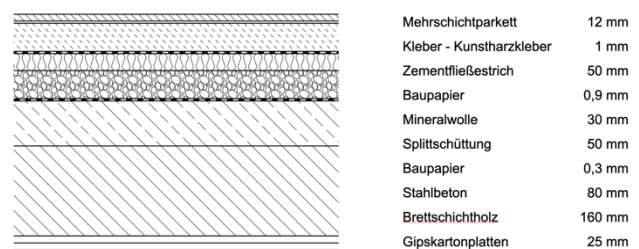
Detail Deckenaufbau Stahlbeton-Hohldielecke (maßstabslos)
